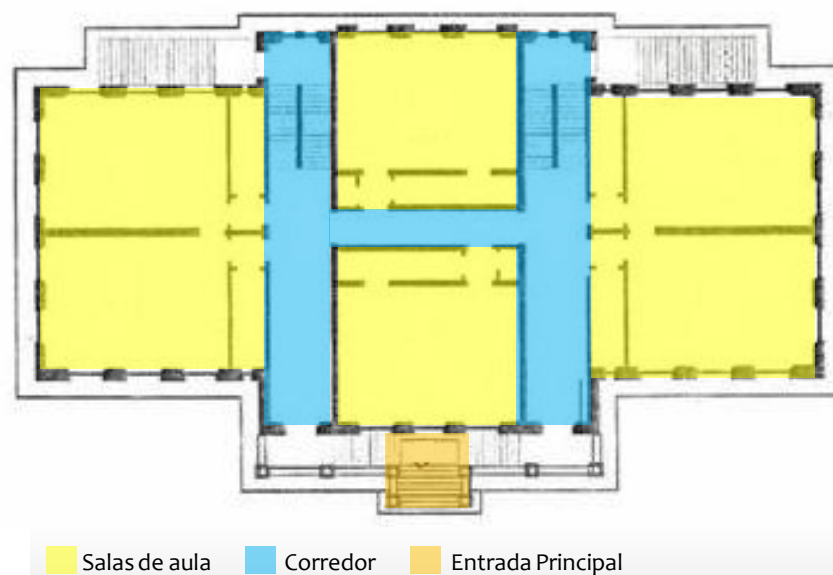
Planta baixa Térreo – Escola Modelo da Luz – Av. Tiradentes –São Paulo – 1897. Projeto do arquiteto Ramos de Azevedo.
